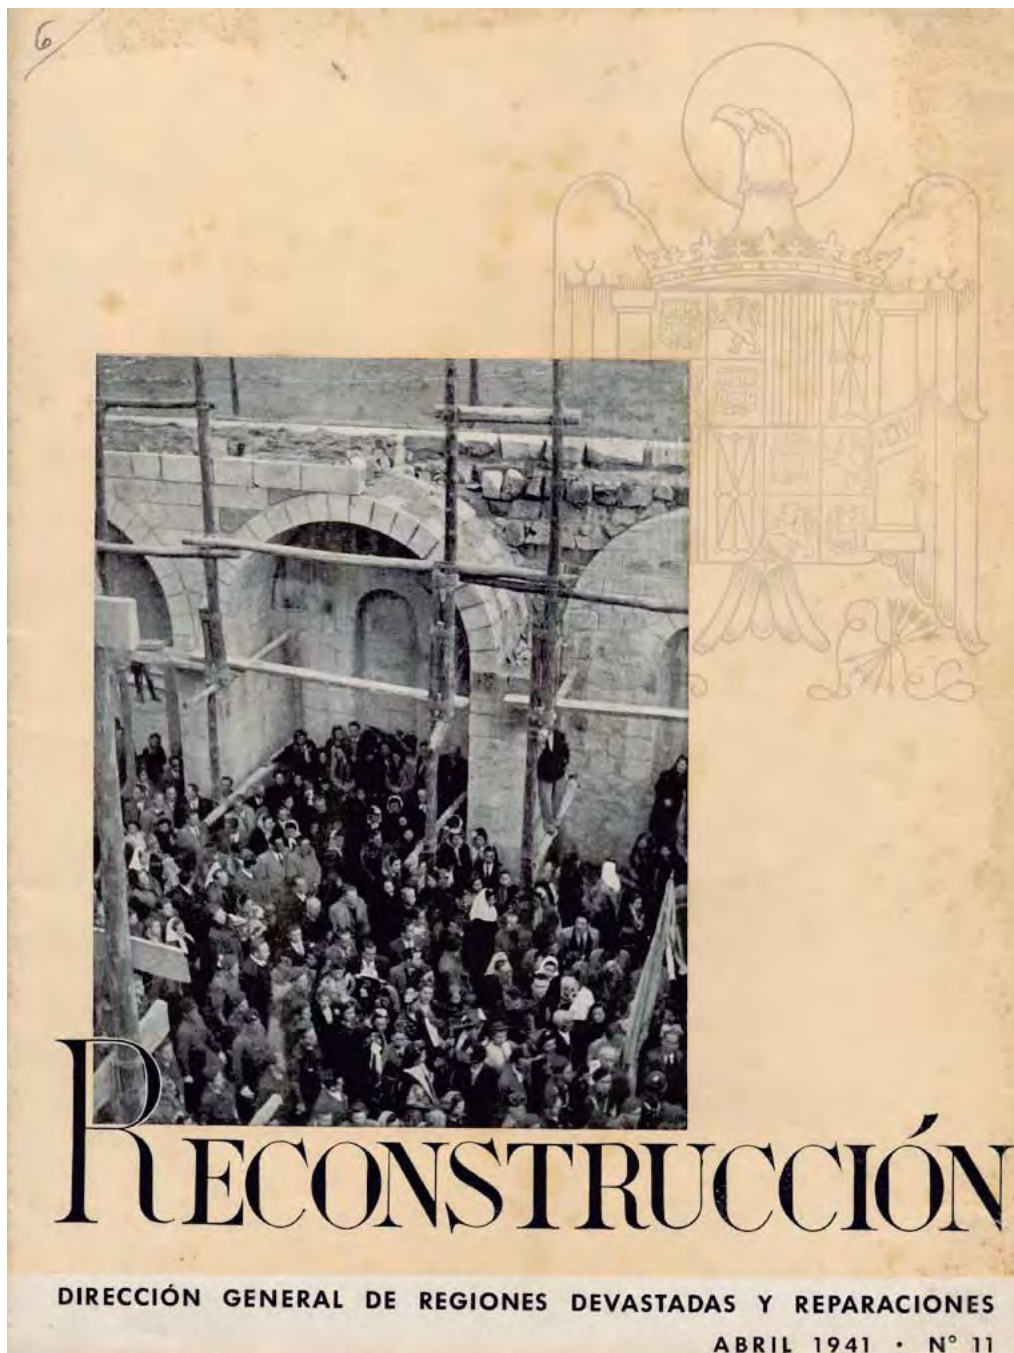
Portada de la revista *Reconstrucción*, nº 1, Madrid, 1941
